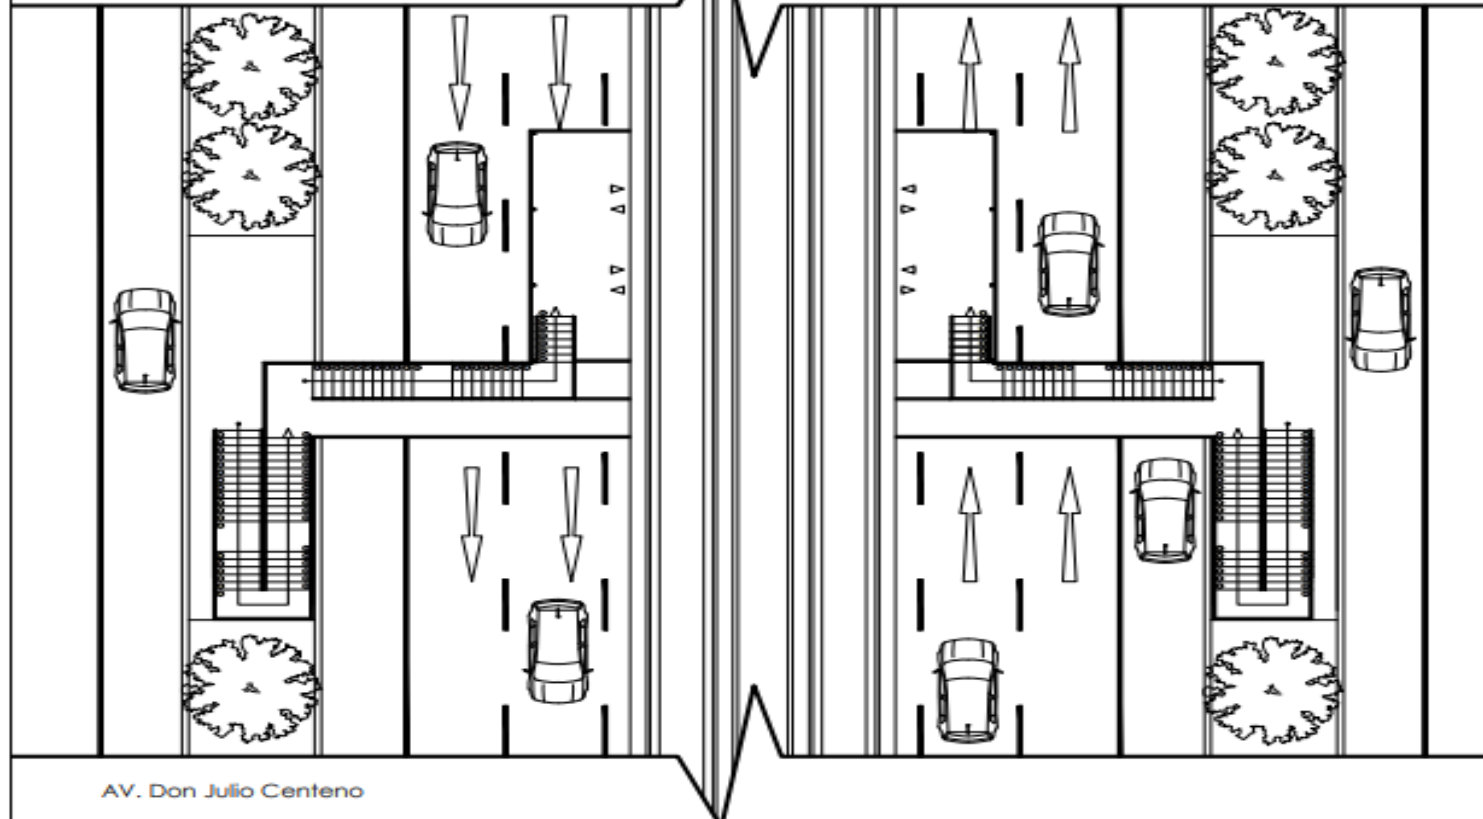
Plano de arquitectura de las estaciones (2018). Fuente: Elaboración propia
